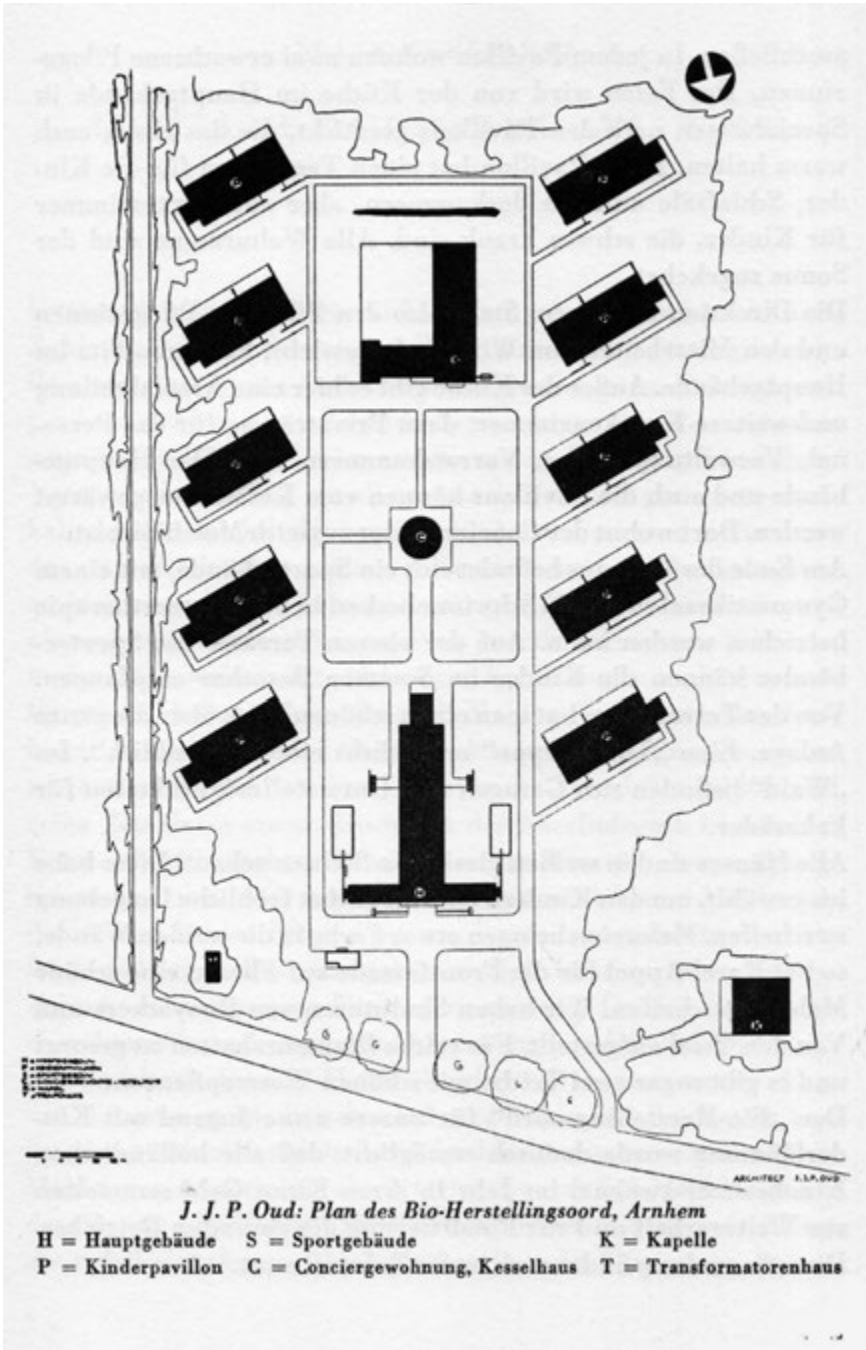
Lageplan des Bio-Herstellingsoord, Arnhem
